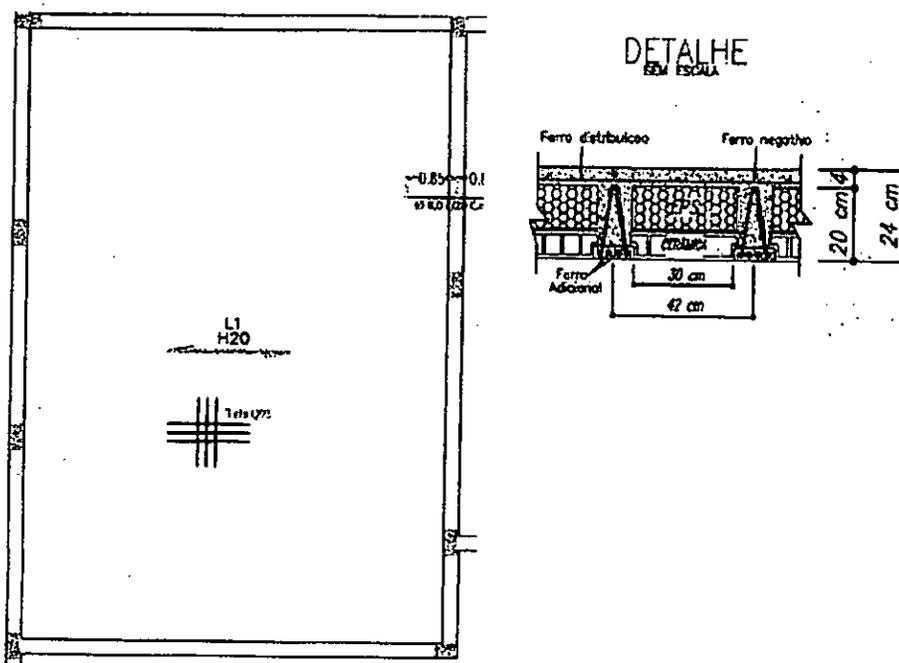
Imagem do detalhamento da laje do mini-plenário e detalhe executivo (ff. EST-3, 13/01/10).
